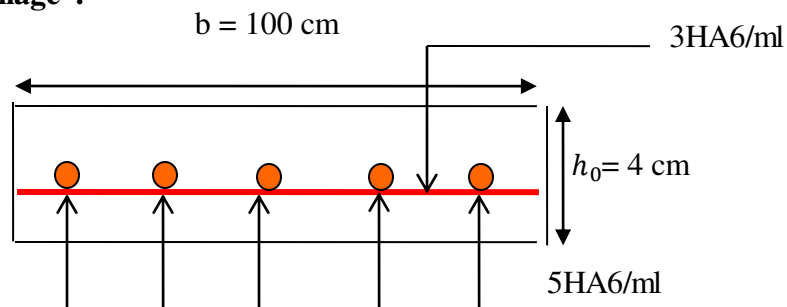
Schéma du ferrailage de la dalle de compression.
